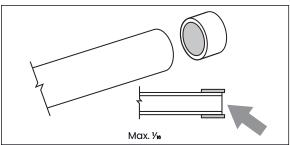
Glisser la bague dilatée sur l'extrémité du tuyau
